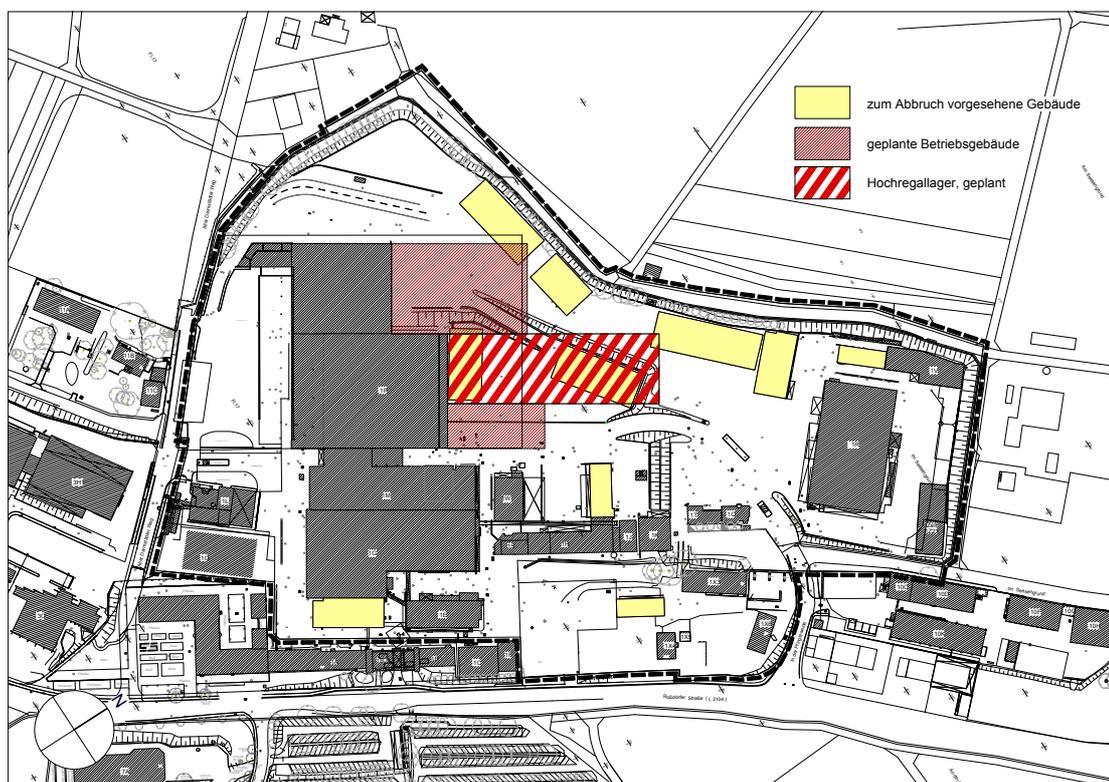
Geplante Bauvorhaben der DAW im Plangebiet
